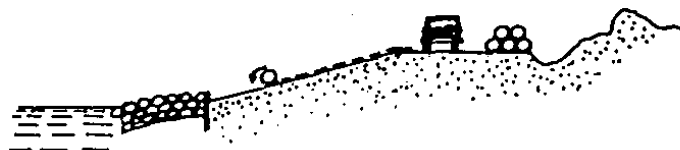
DESEÑOLLADO DEL GEOTEXTIL SOBRE EL TALUD
